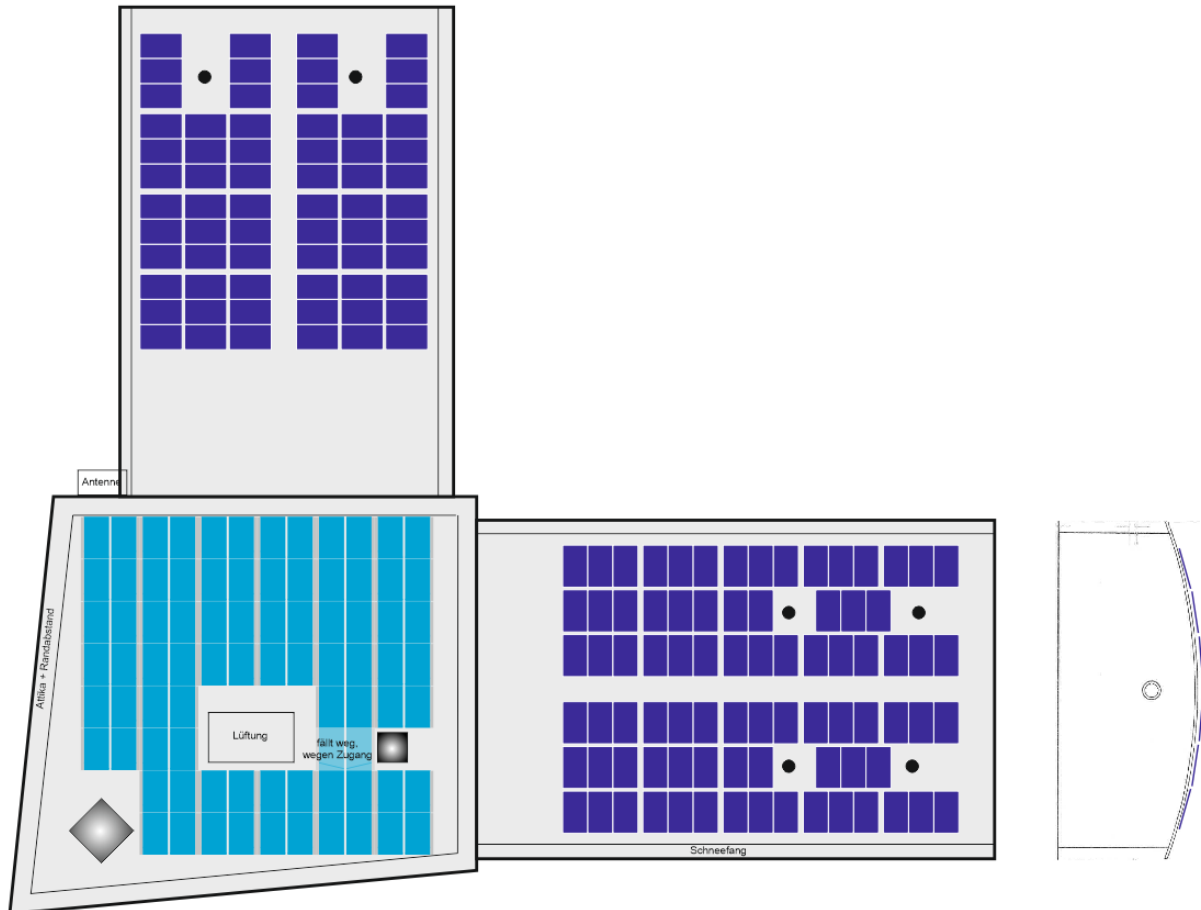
Mögliche Belegung des Daches mit 80 Solarmodulen auf dem Flachdach und 148 Modulen auf den Fahrzeughallen. Weitere Details können dem Anhang entnommen werden.
